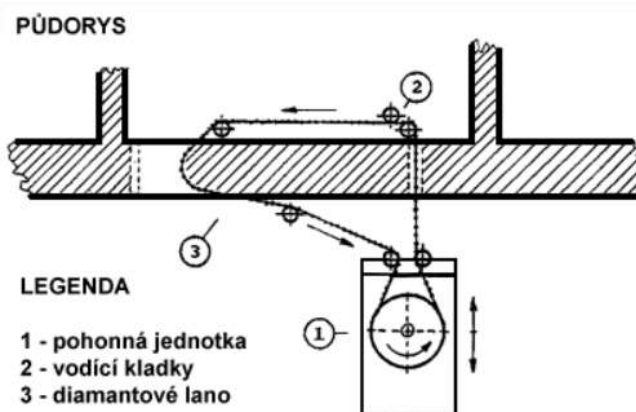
Podřezání zdiva pilou s pojezdem stroje [27]
